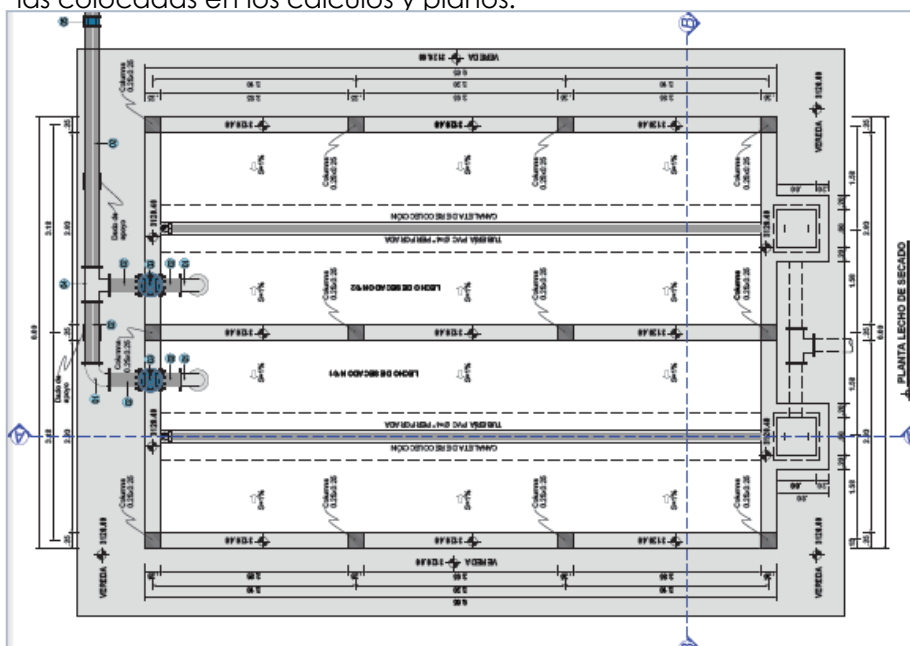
DETALLE DE LECHO DE SECADO PLANTA
